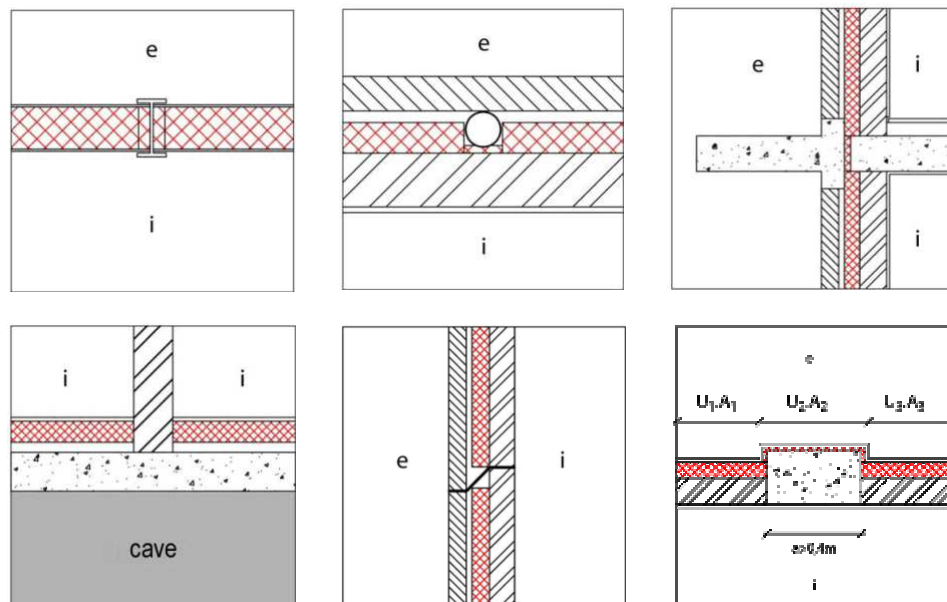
exemples de nœuds constructifs dus à l'interruption de la couche isolante. En haut à gauche, la couche isolante est interrompue par un profil en acier et, au centre, par une conduite d'eau pluviale. À droite, l'épaisseur de la couche isolante est diminuée à l'endroit du raccord de balcon. En bas à gauche, la couche isolante du plancher est complètement interrompue par le mur intérieur. En bas au centre, le raccord de la couche isolante par une étanchéité dont l'exécution négligente interromp l'isolation par une couche d'air.
